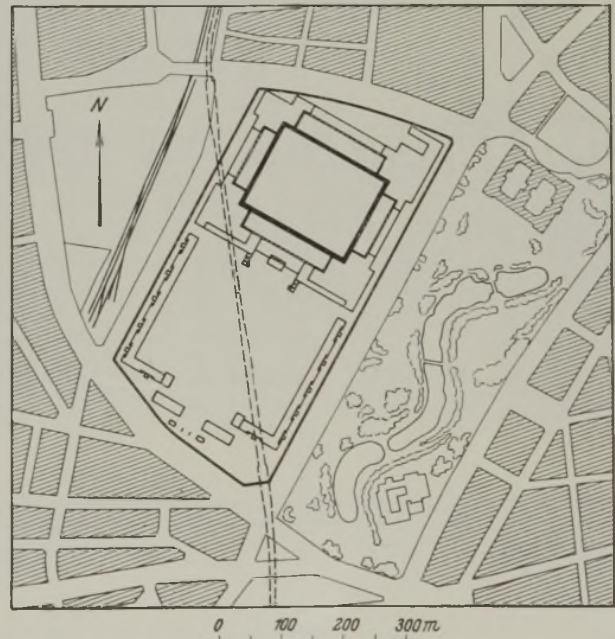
Lageplan. Entwurf Peter Behrens, Wien.
